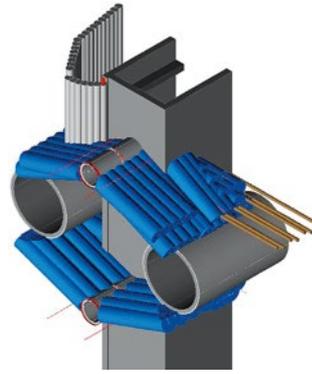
Nord-Süd-Stadtbahn Köln, Haltestelle Severinstraße. 3D-Planung des Frostkörperanschlusses der Tunnelröhren an das Zugangsbauwerk
